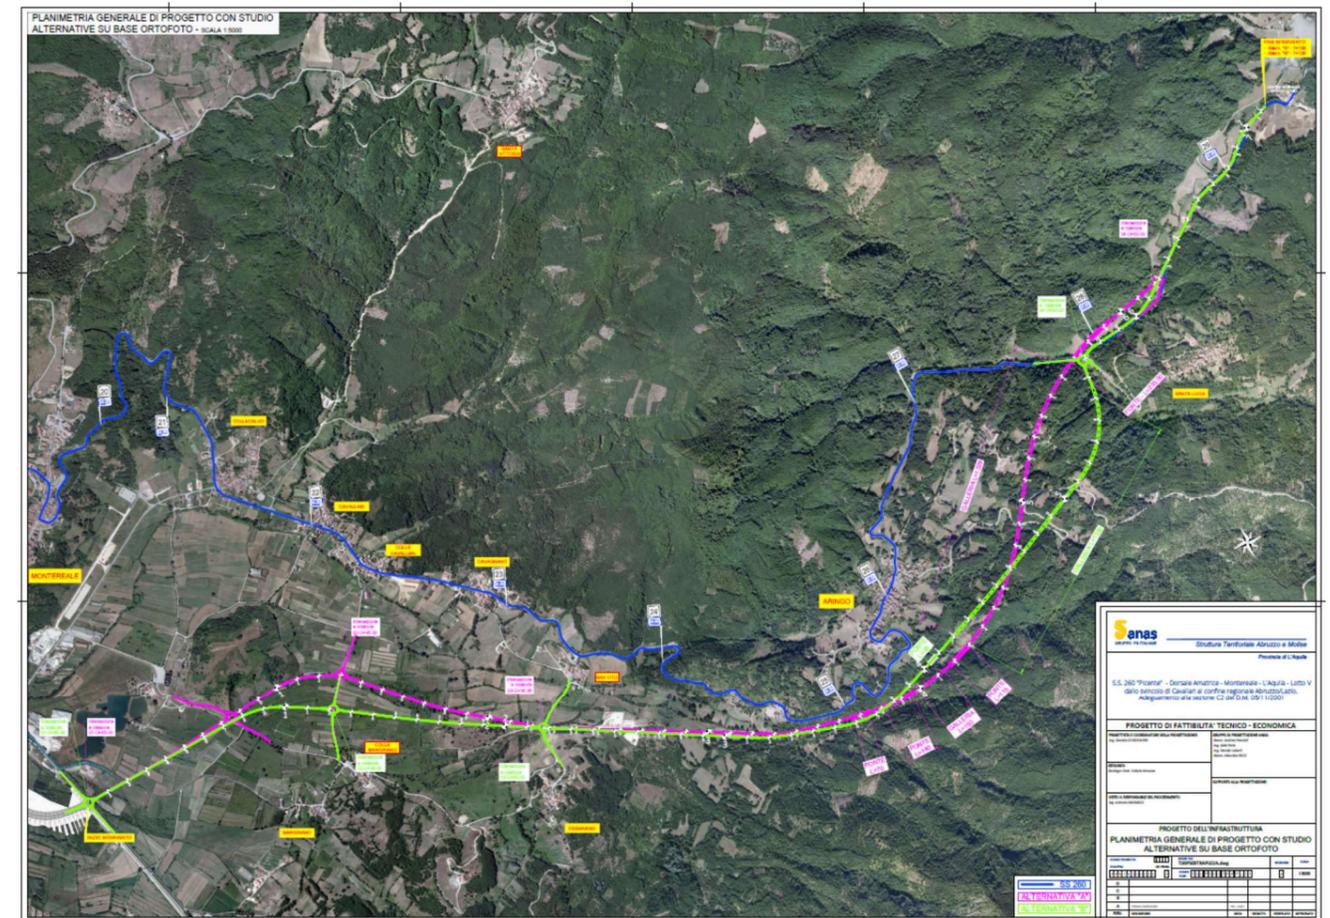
Inquadramento planimetrico delle alternative progettuali
